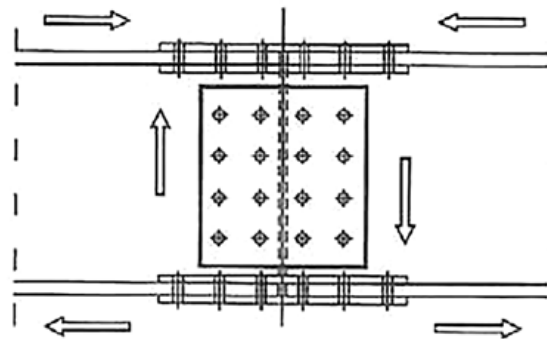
Assemblages sollicités perpendiculairement à l'axe des rivets (bibliographie [6]).
